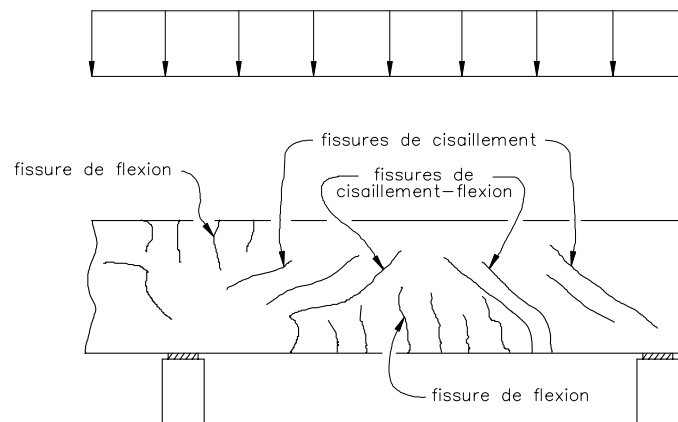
Fissuration type d'une poutre en béton armé
